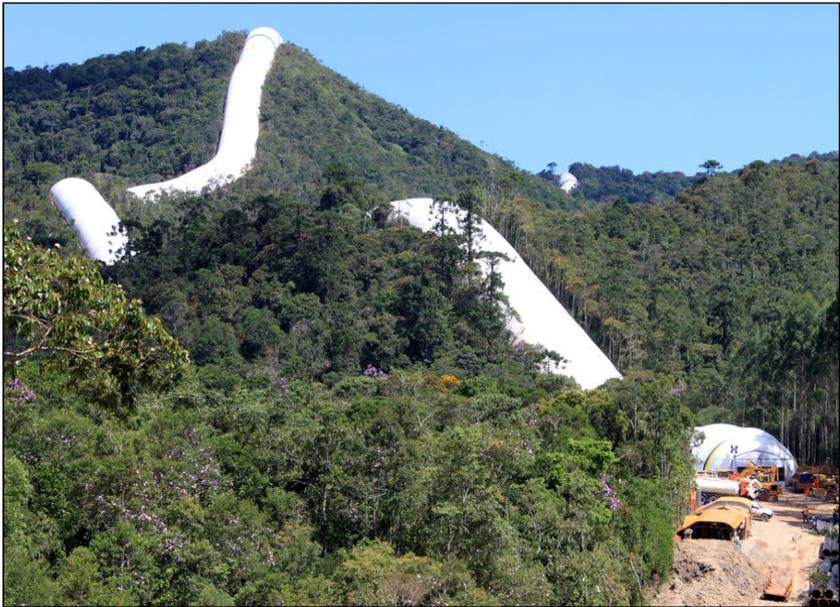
Vista parcial da cobertura insuflável implantada no trecho entre o km 08+300 e km 11+600 da faixa (Fonte: Petrobras, fev/10).
